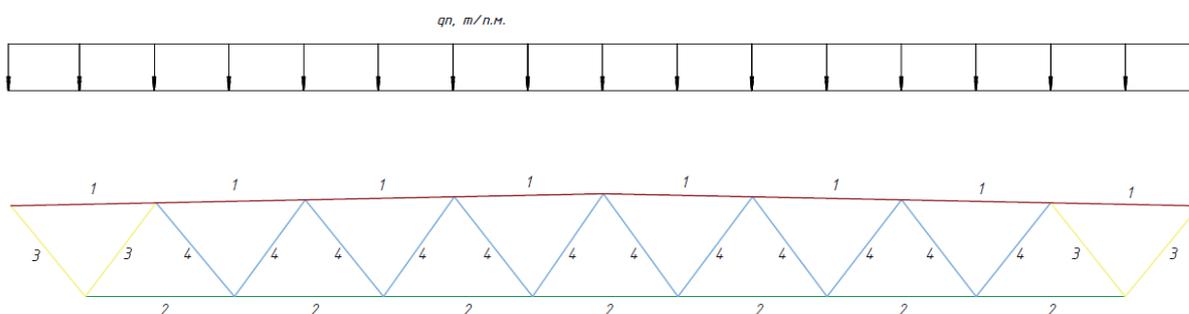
Схема приложения нагрузки от веса покрытия
